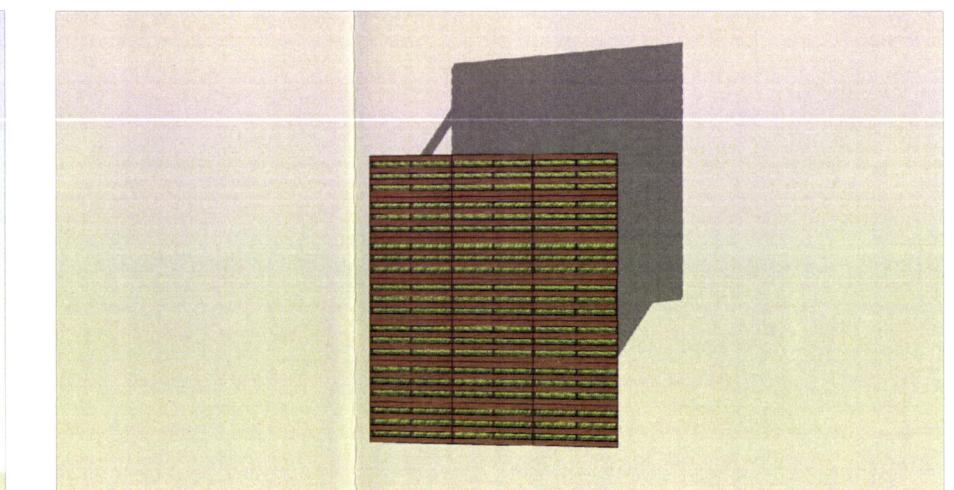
Planta da Cobertura do Alpendre, com plantação de herbáceas
